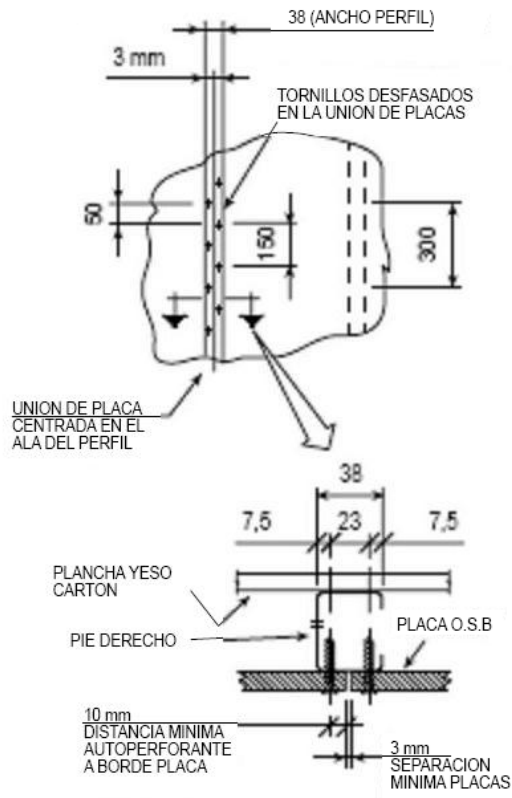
Anclaje típico de placa a perfiles metálicos para muros
